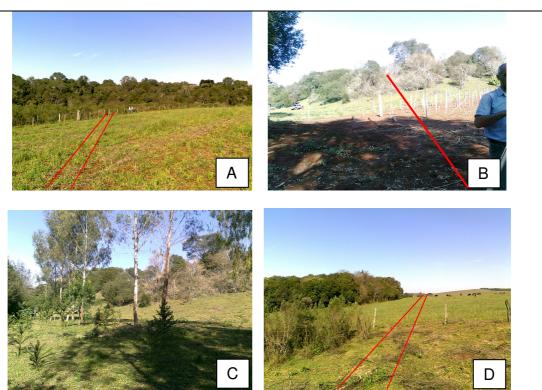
Vegetação existente próximo ao local de barramento e local de construção das estruturas físicas.
